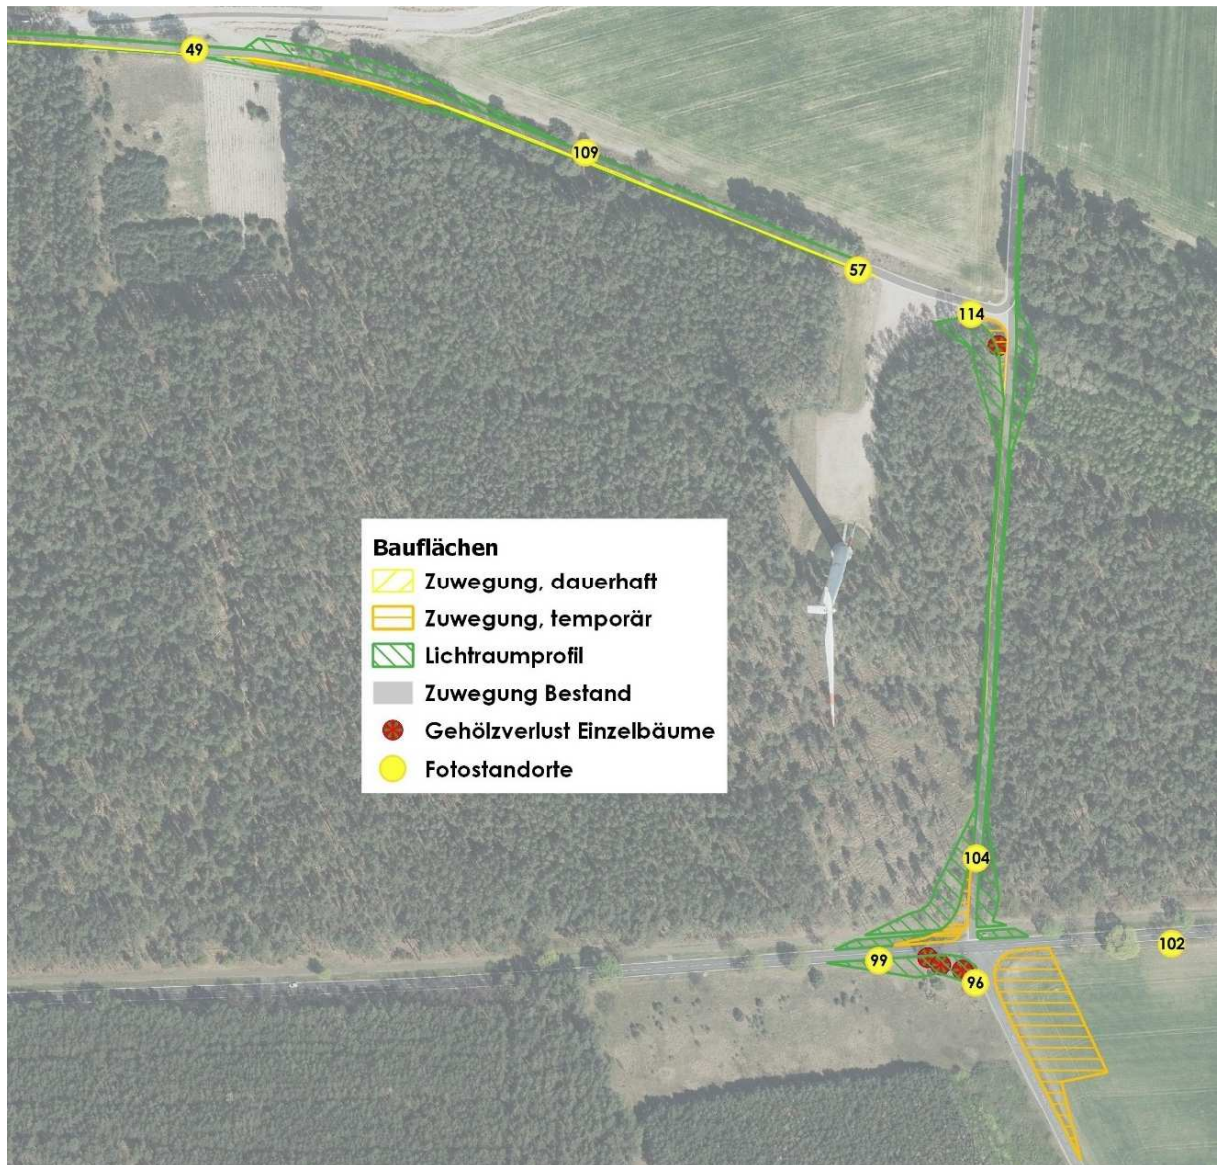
Luftbild mit Bauflächen Erschließung WKA-Standort 1
